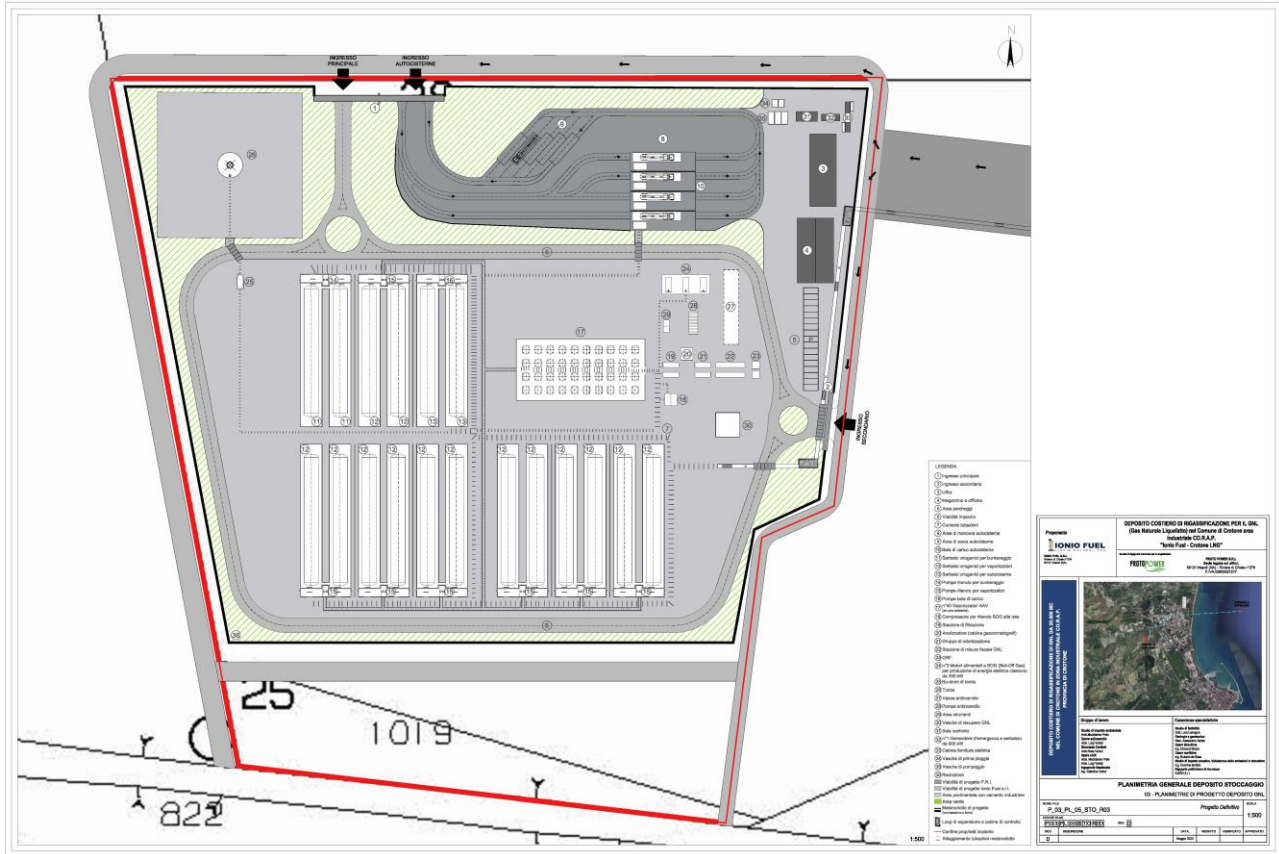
P\_03\_PL\_05\_STO\_R03 Planimetria generale Deposito di stoccaggio
